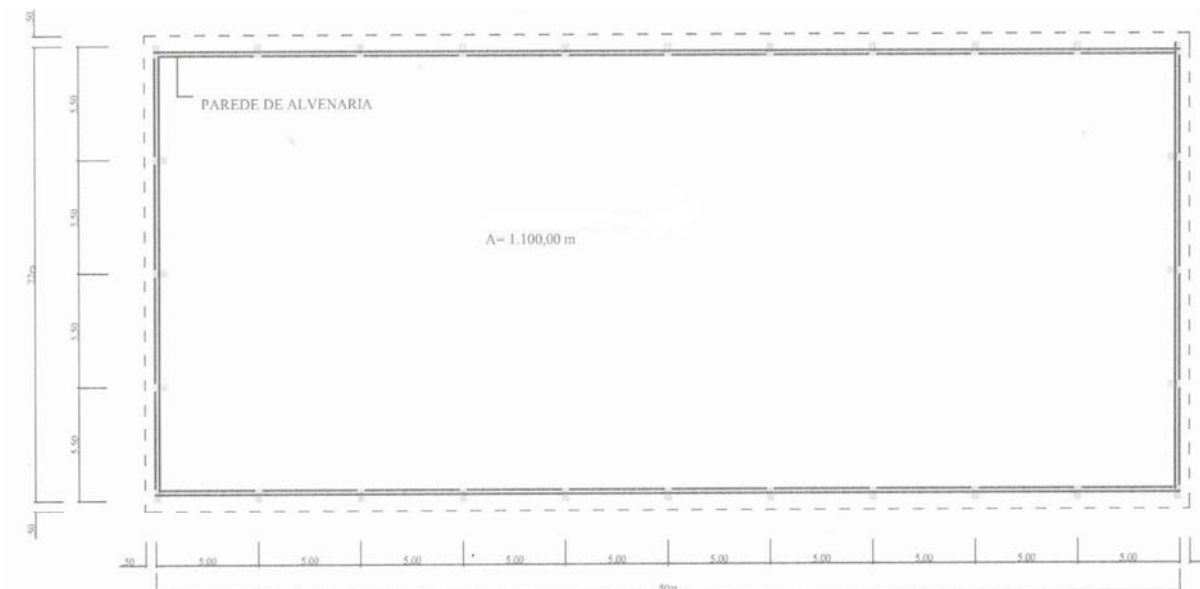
Planta Pavilhão Projeto (Obra 1)
